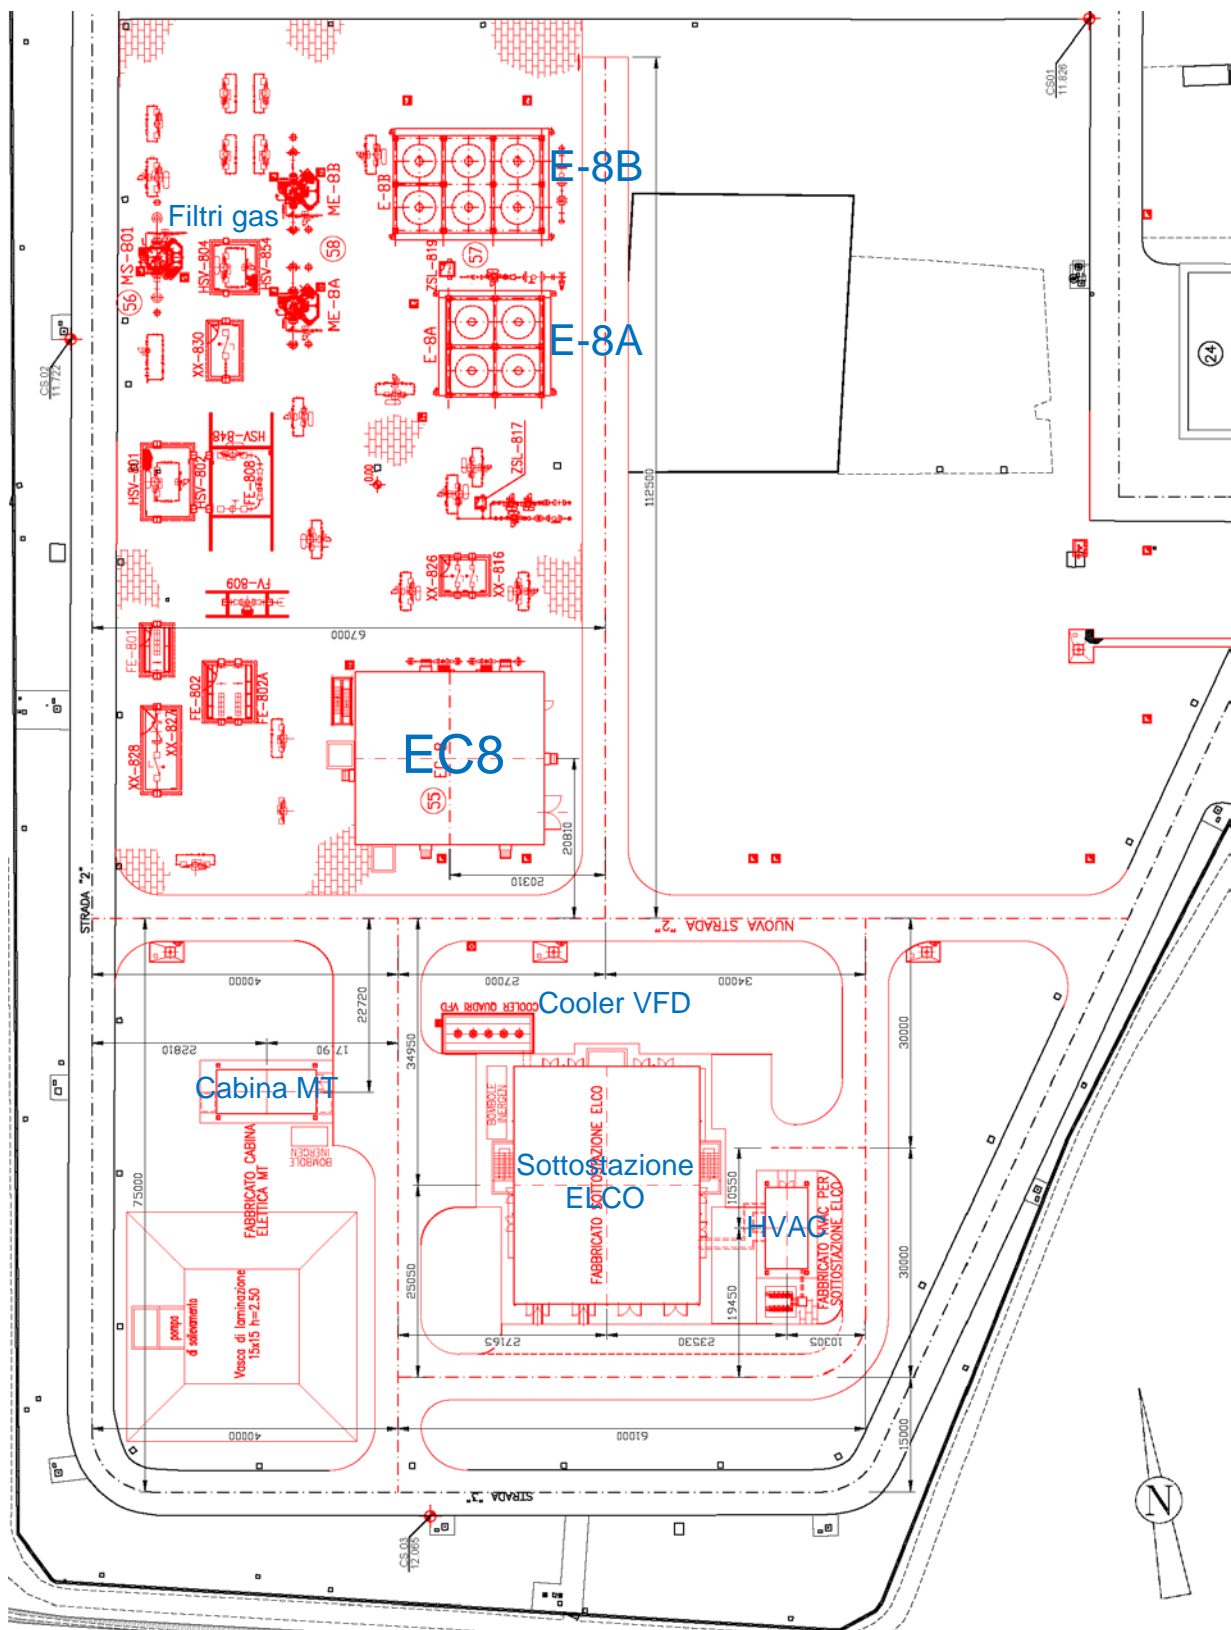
Stralcio della planimetria della centrale, con evidenziazione delle apparecchiature di prossima costruzione (rosso)
